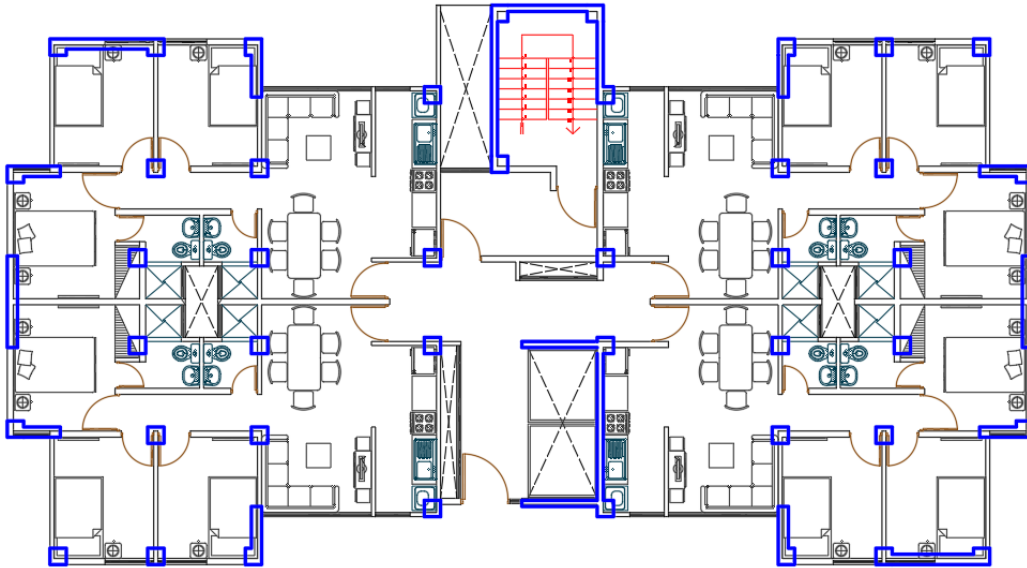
Distribución de Columnas y Muros de corte para el Sistema DUAL – Edificio Blesser. Fuente: Elaboración Propia.
